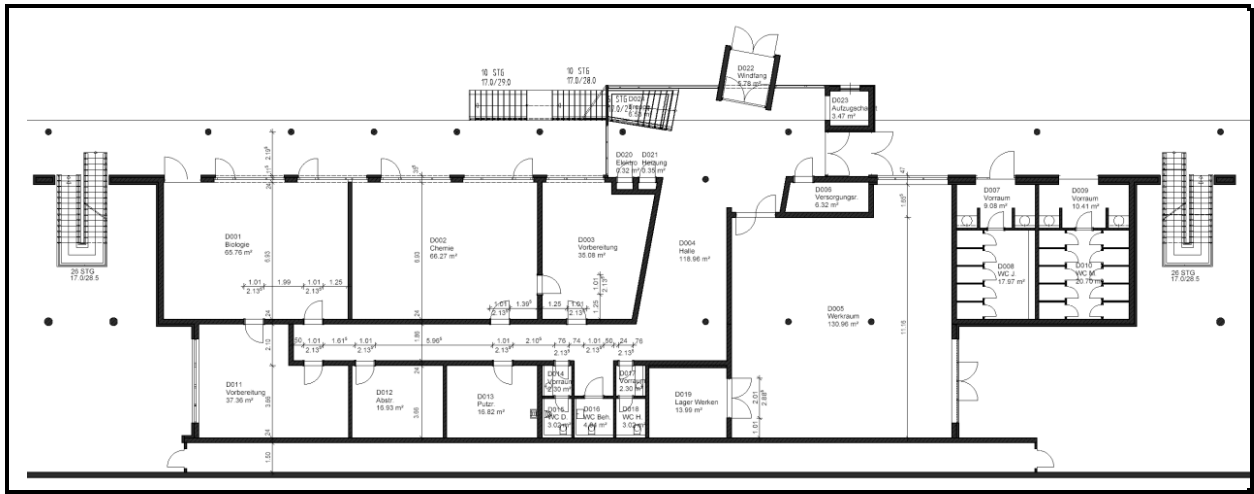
Ernst-Mach-Gymnasium: Grundriss Bauteil D
